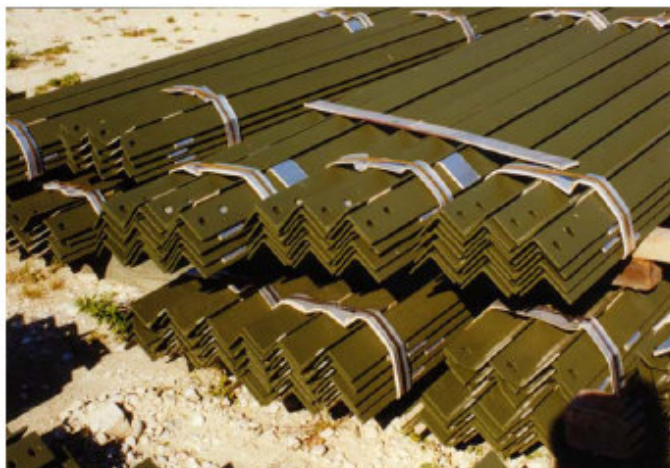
Связка покрытых элементов опоры, готовая к транспортировке на место установки
